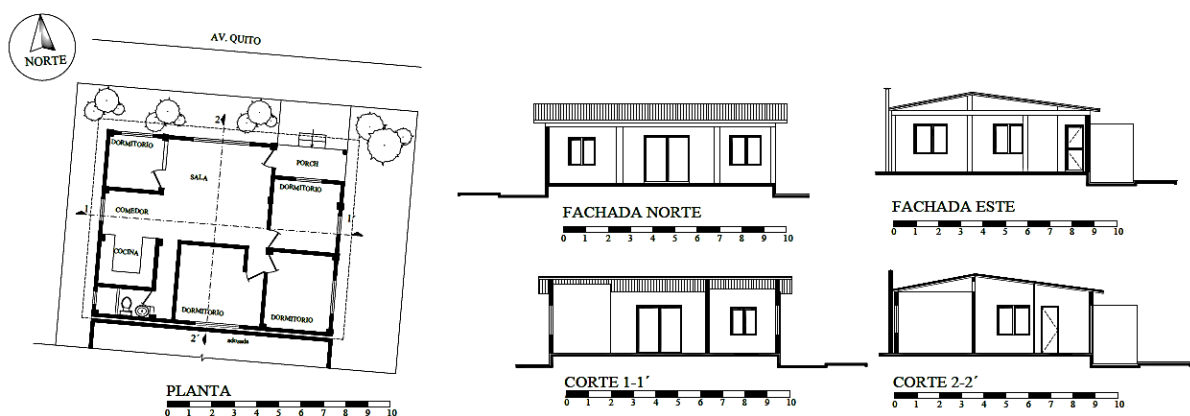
Planta, cortes y fachadas vivienda 2. Elaboración propia 2017
